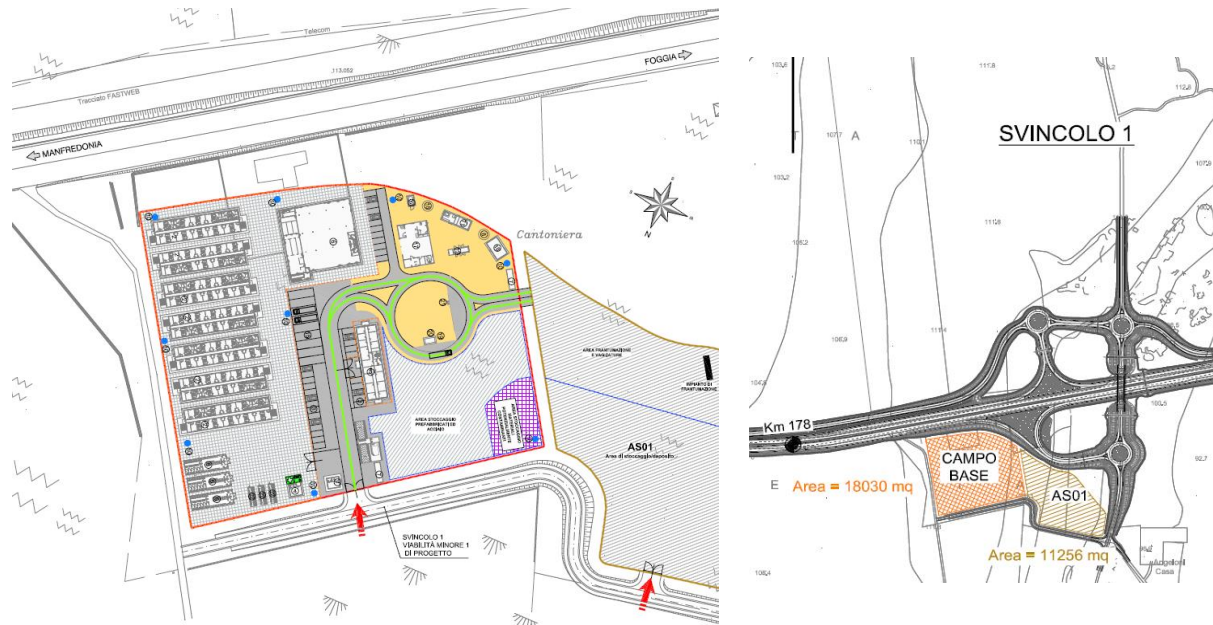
Campo Base – Km 178+300: Layout ed ubicazione
